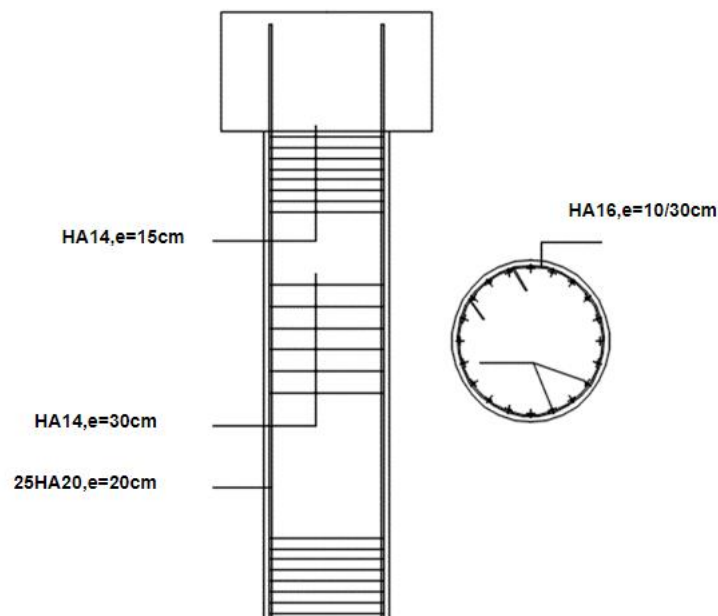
coupe transversale et longitudinale du ferrailage du fut
